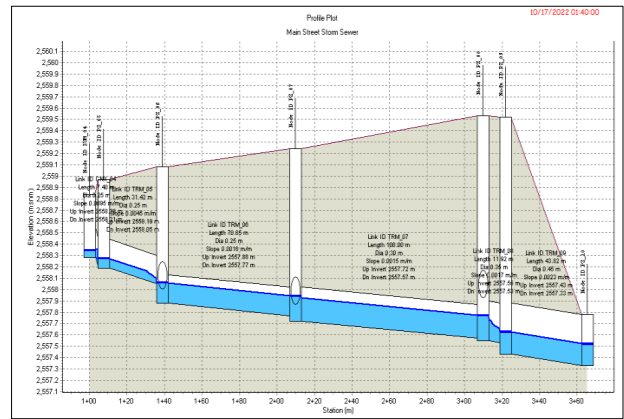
Perfil del sistema de drenaje de la calzada oriental. Sistema tradicional.
